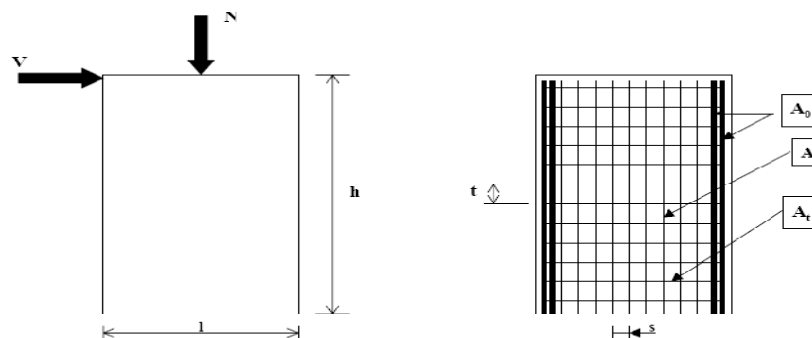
Schéma d'un voile plein et disposition du ferrailage
